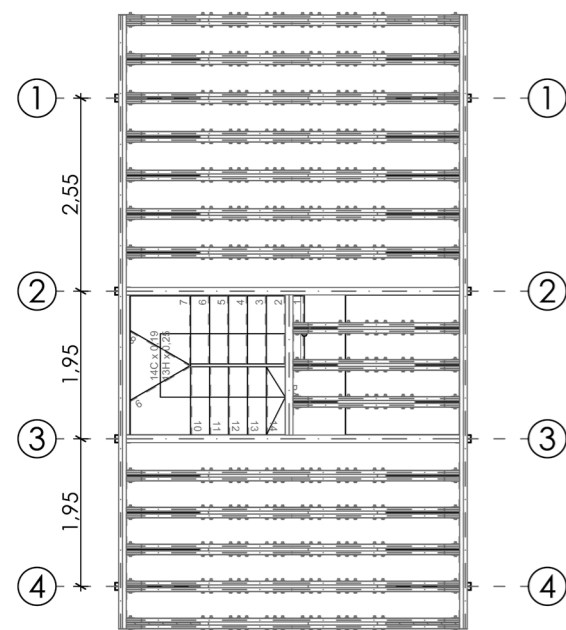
Planta del Entrepiso Mixto I aplicado a Molinos de Capulispamba
